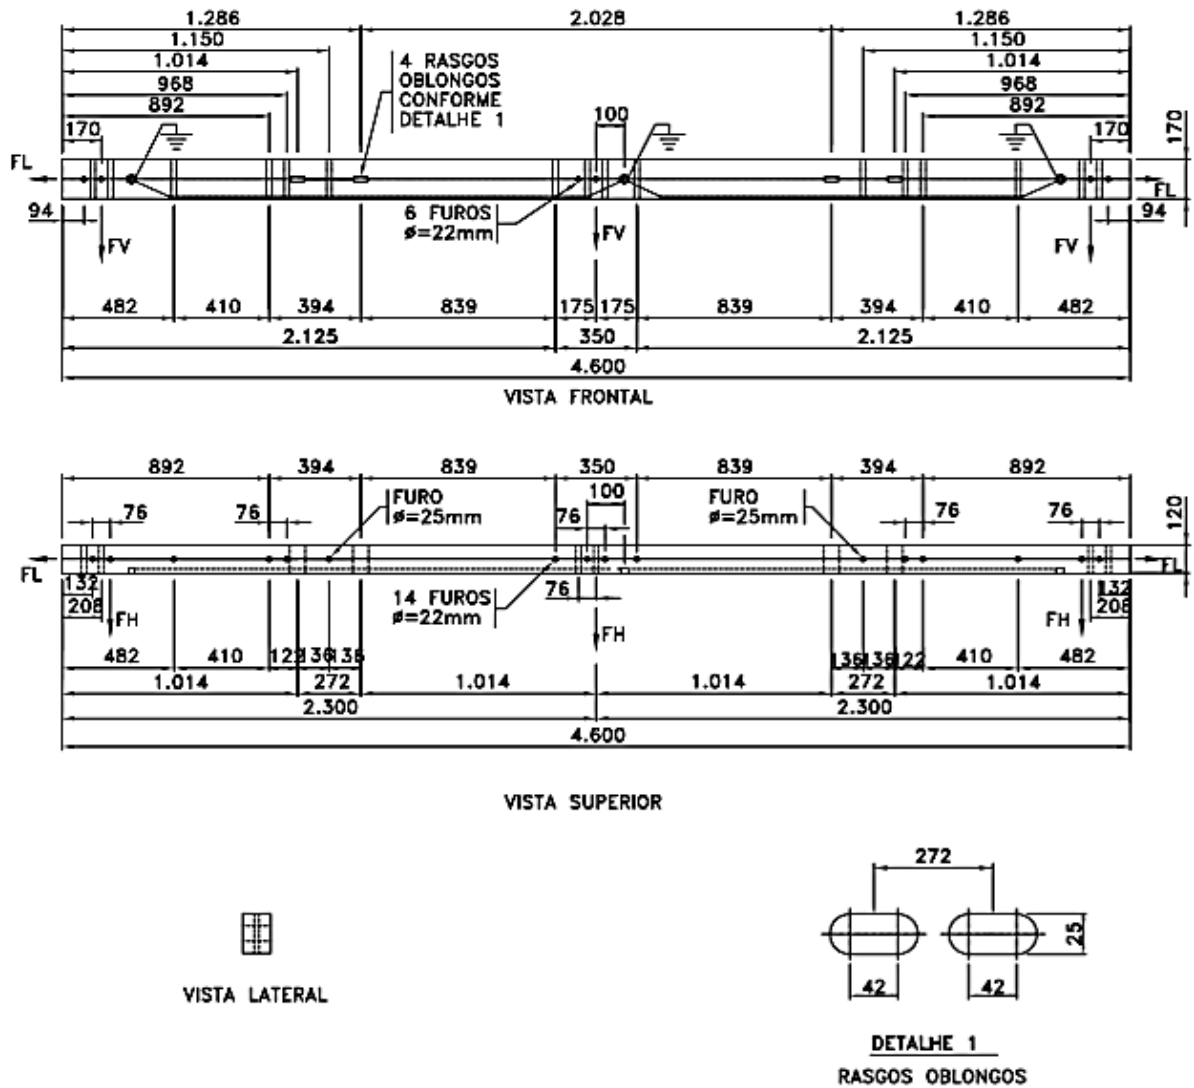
Viga de concreto armado de 120x170x4.600mm, montagem vertical
